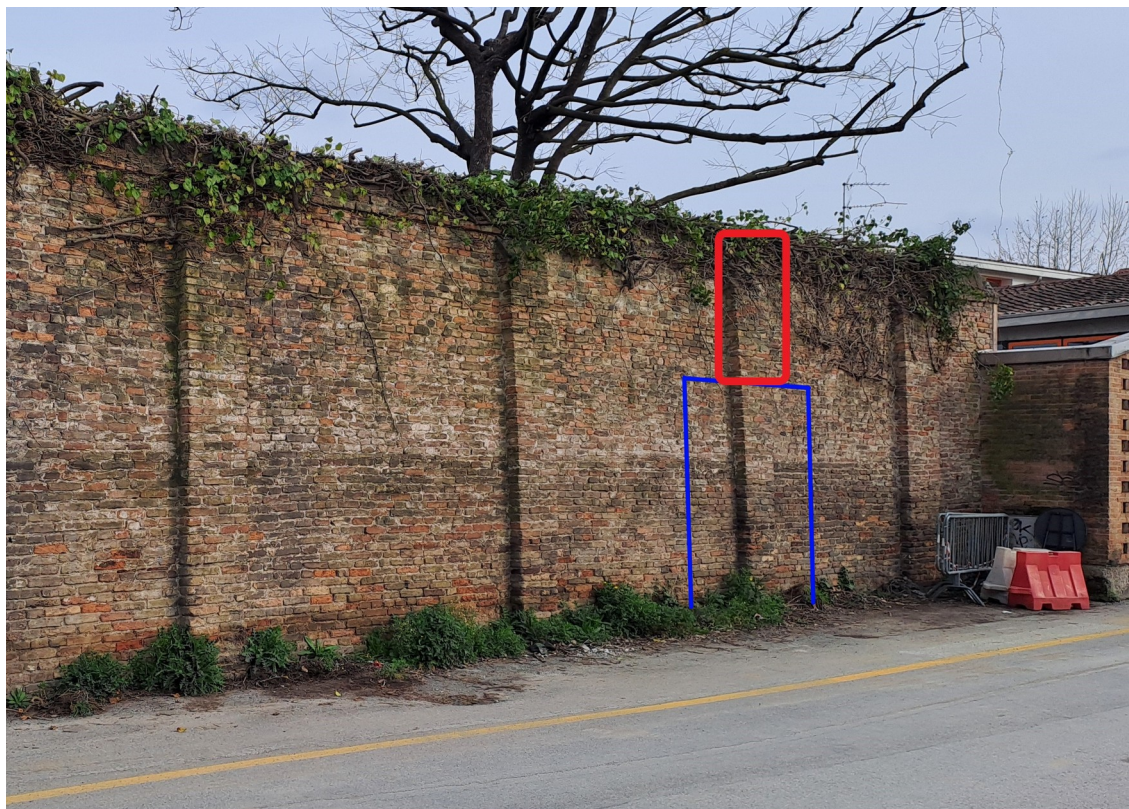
intervento nuova apertura nel muro (vista dall'esterno)
